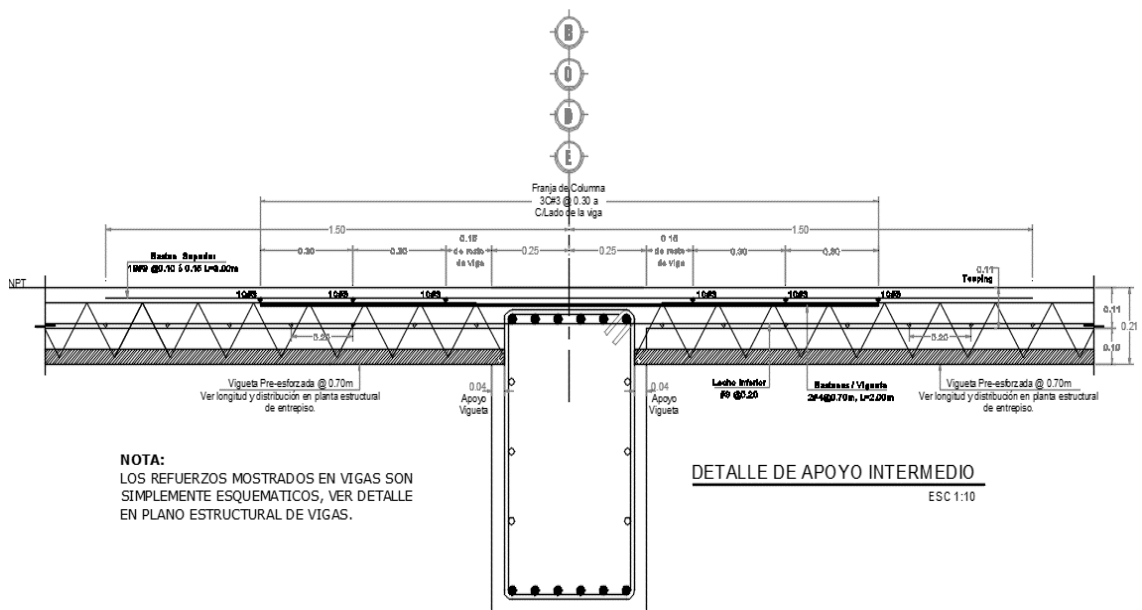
13 Detalle de apoyo intermedio en losa aligerada.
